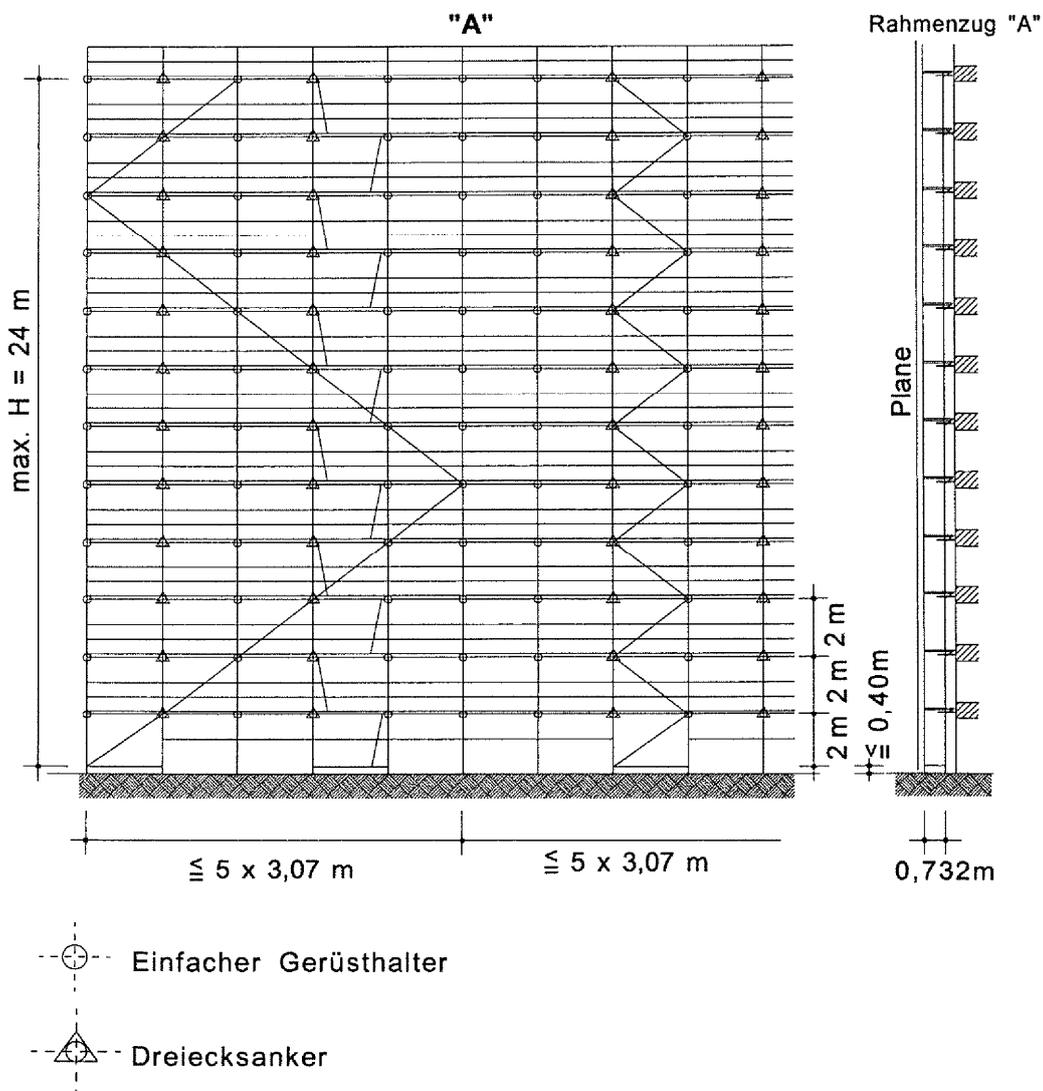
Mit Planen bekleides Gerüst mit Innenkonsolen ABKK vor offener Fassade
